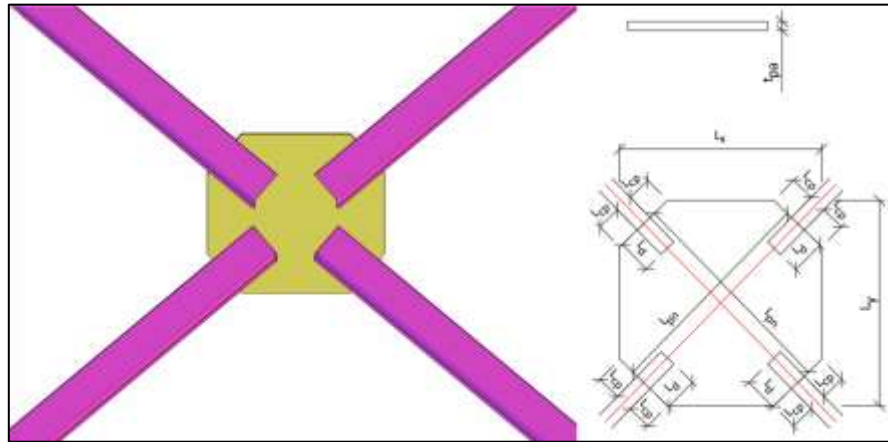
Conexión a corte Gusset Plate Central - Techo (Perfiles: alma llena)
